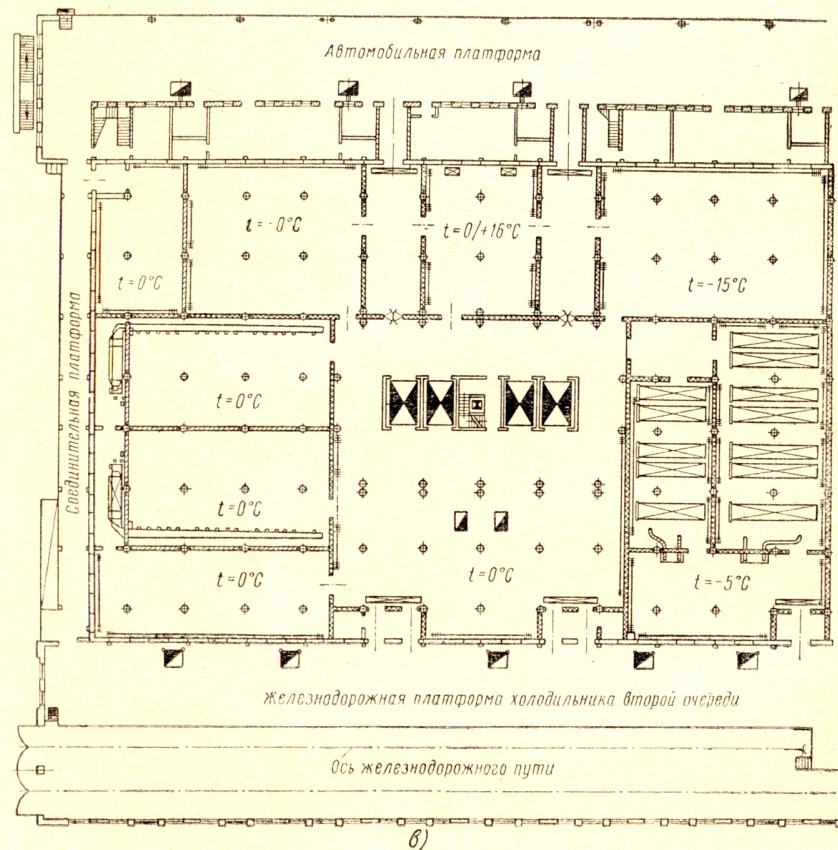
в. Планировка первого этажа второй очереди строительства холодильника № 12 в Москве
